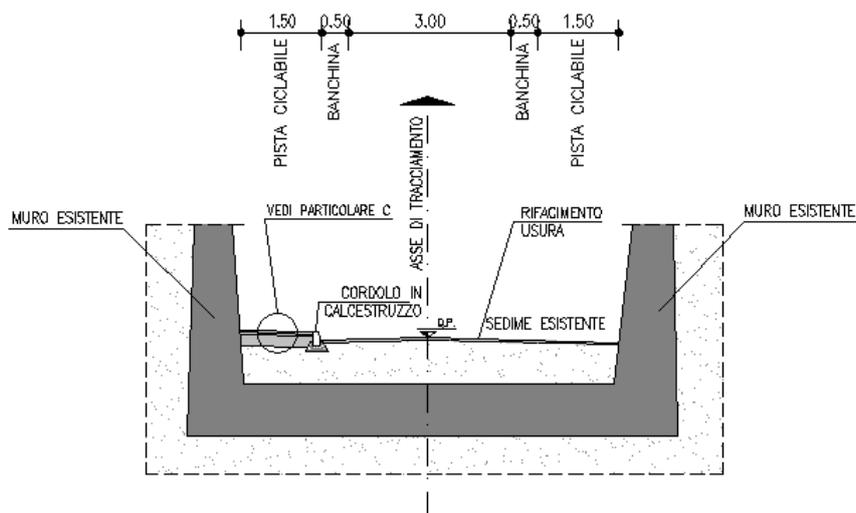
Sezione tipo di progetto via Piave nel tratto in sottopasso e fra muri
